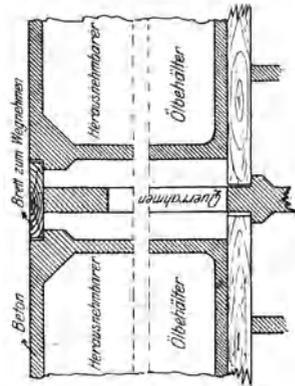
Ölprahm, Detailzeichnung-Längsschnitt.
